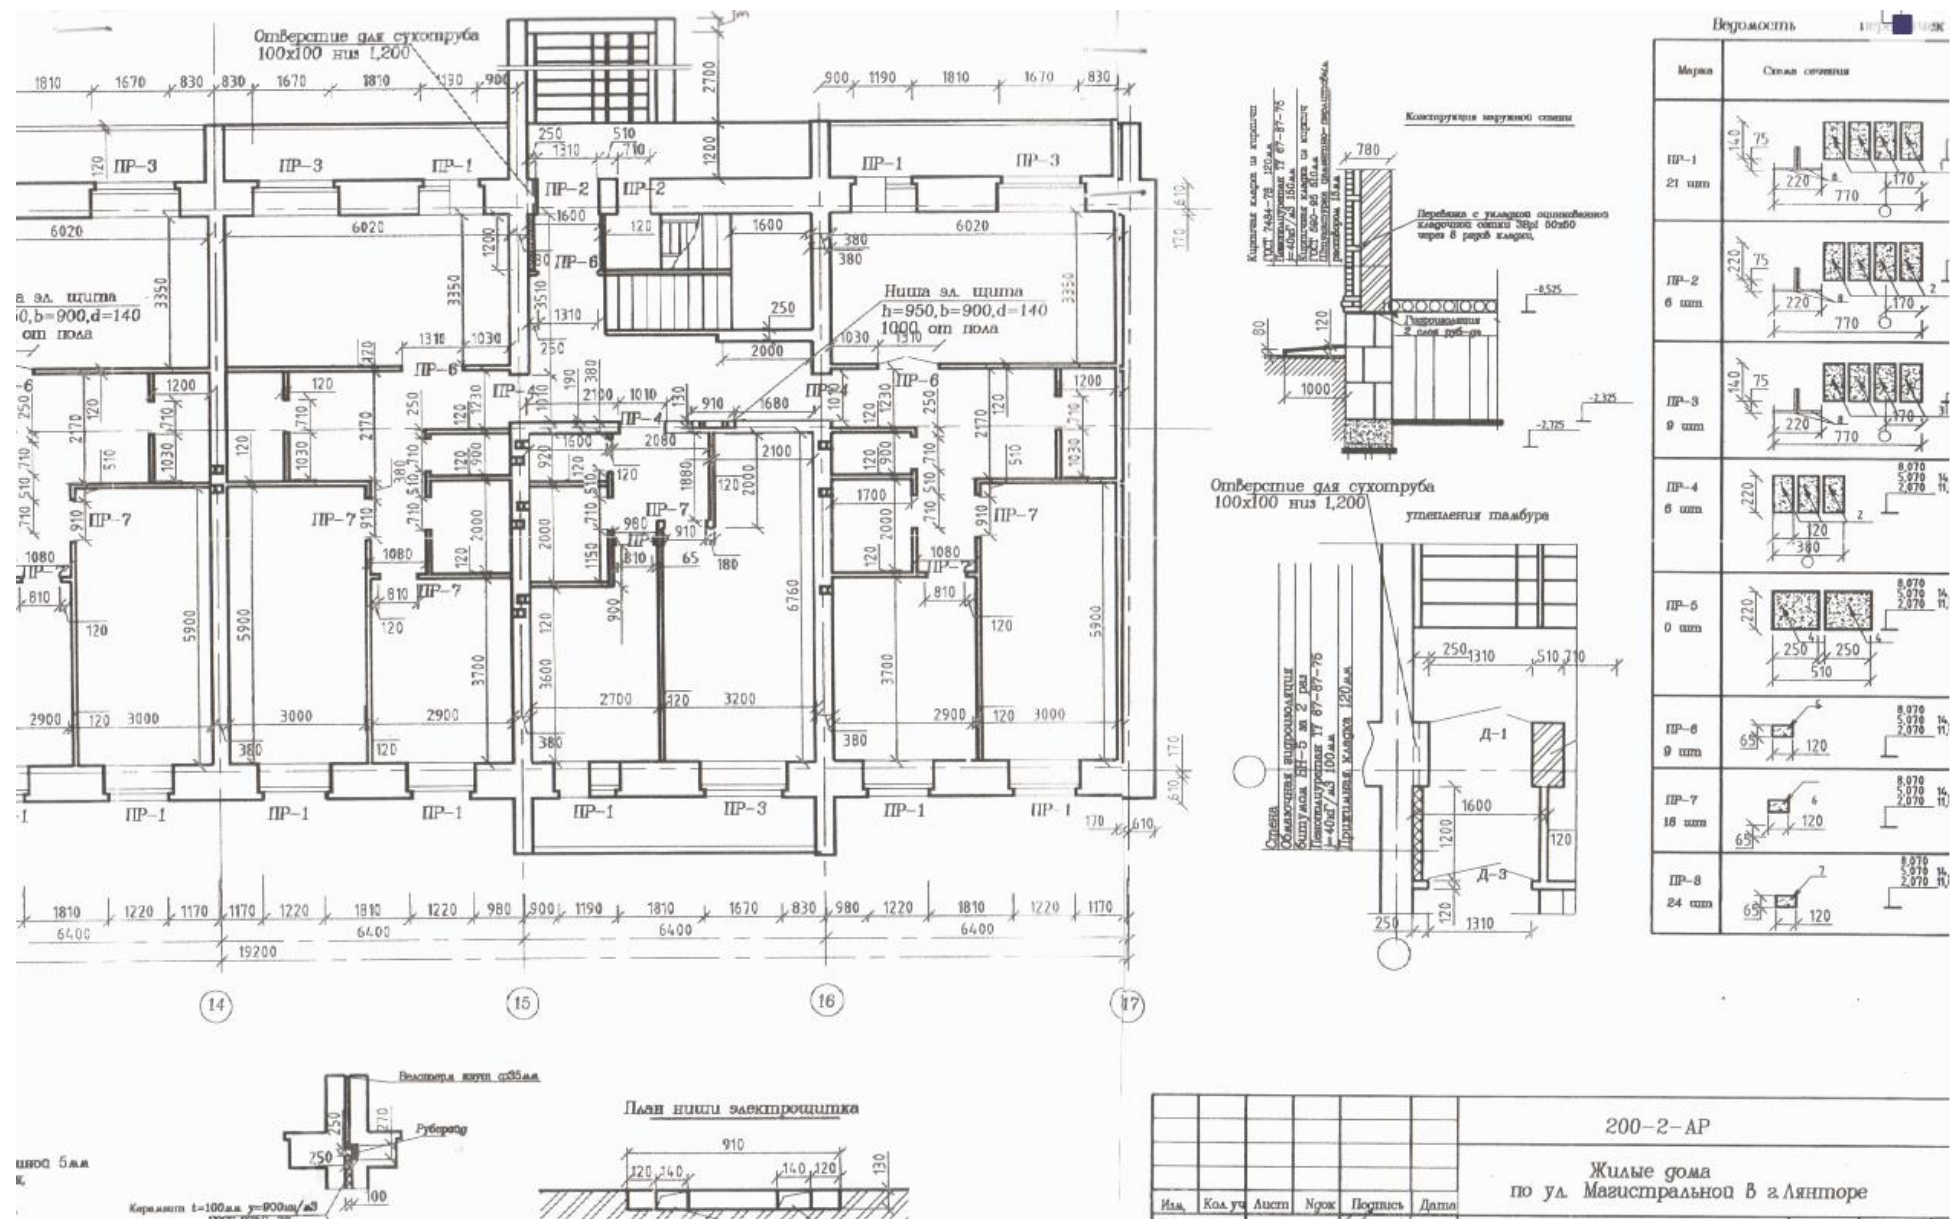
Кладочный план 1-го этажа типовой блок секции.
